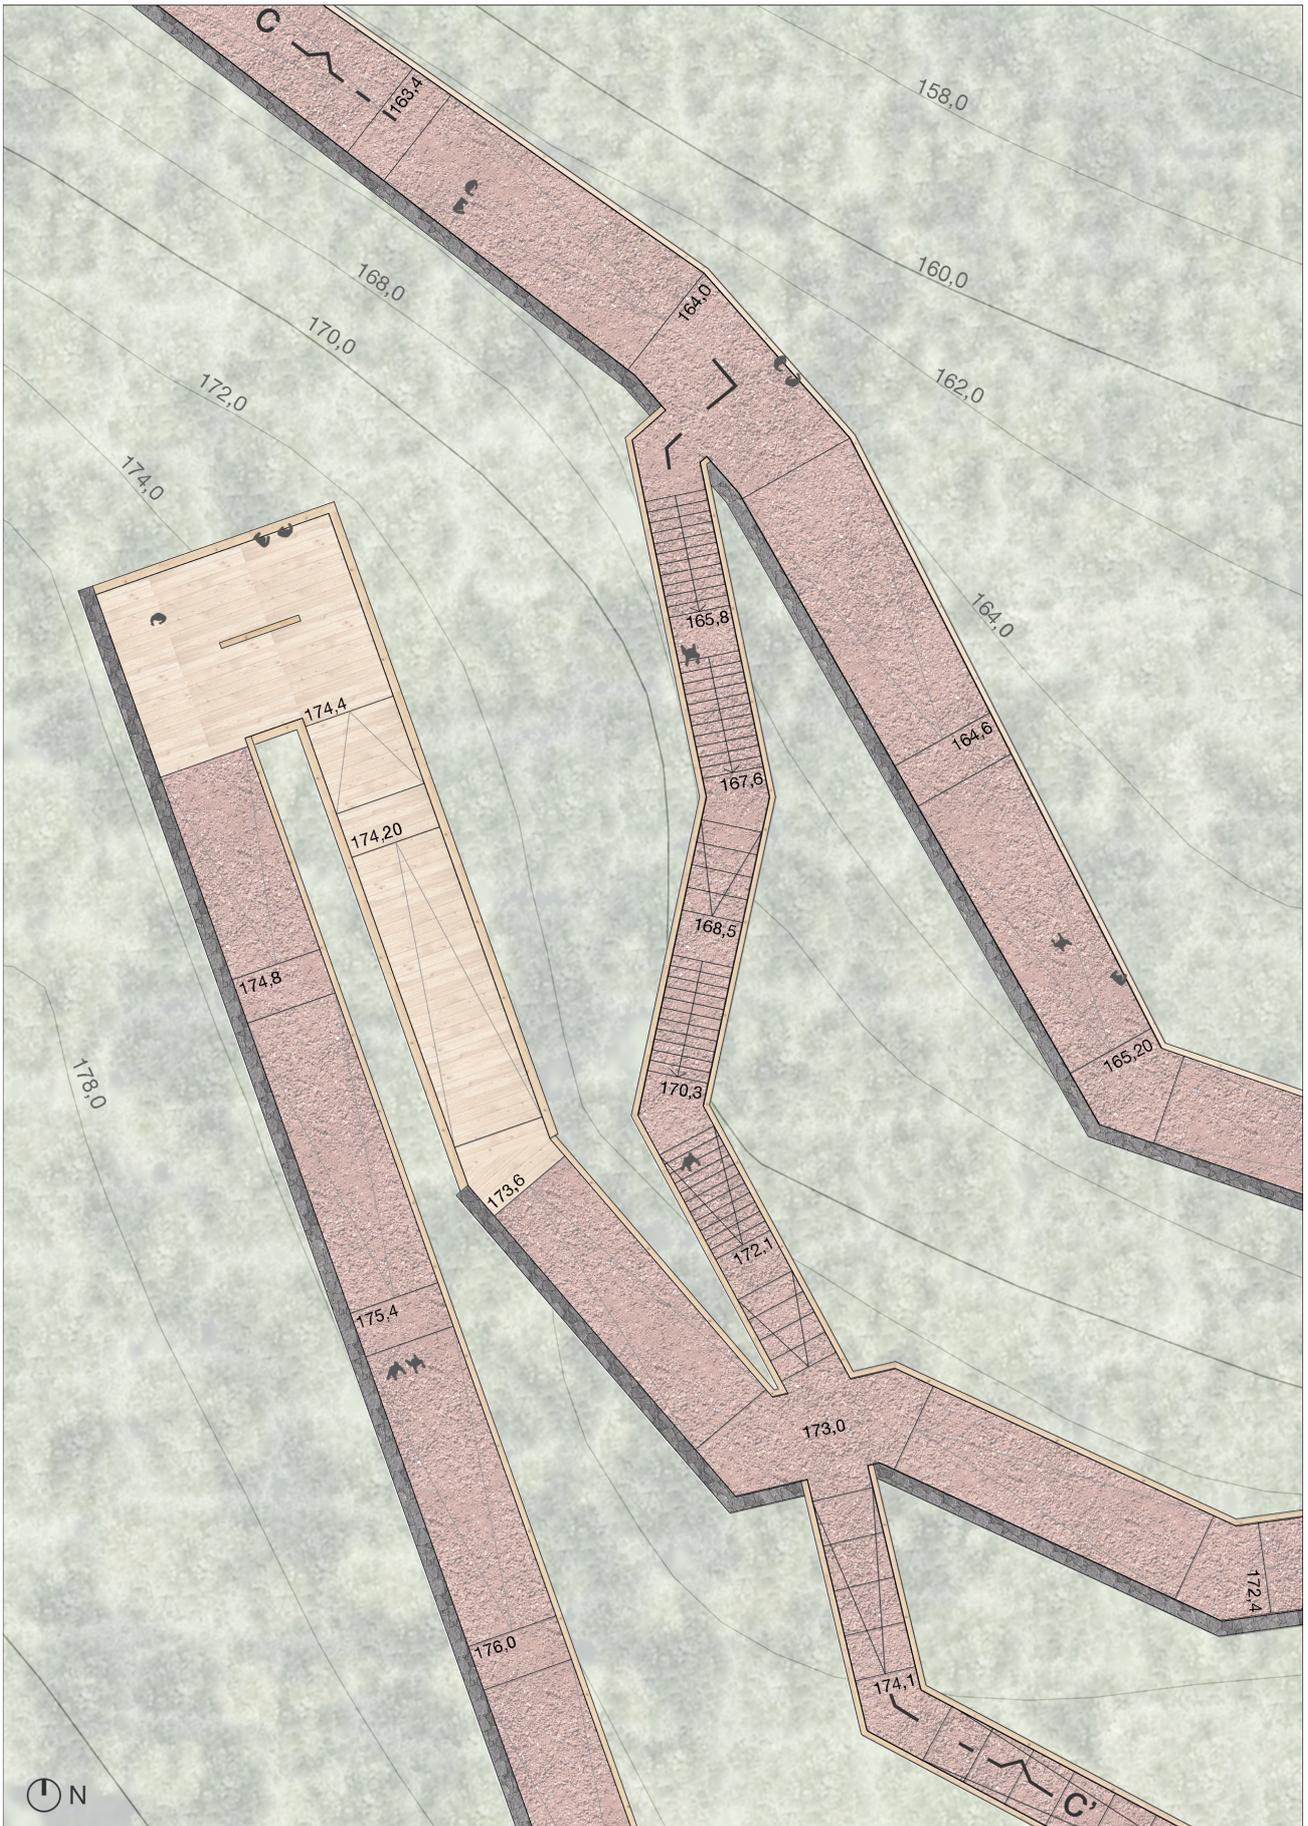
Planta de implantação do Percurso – Troço Norte, escala 1:200
